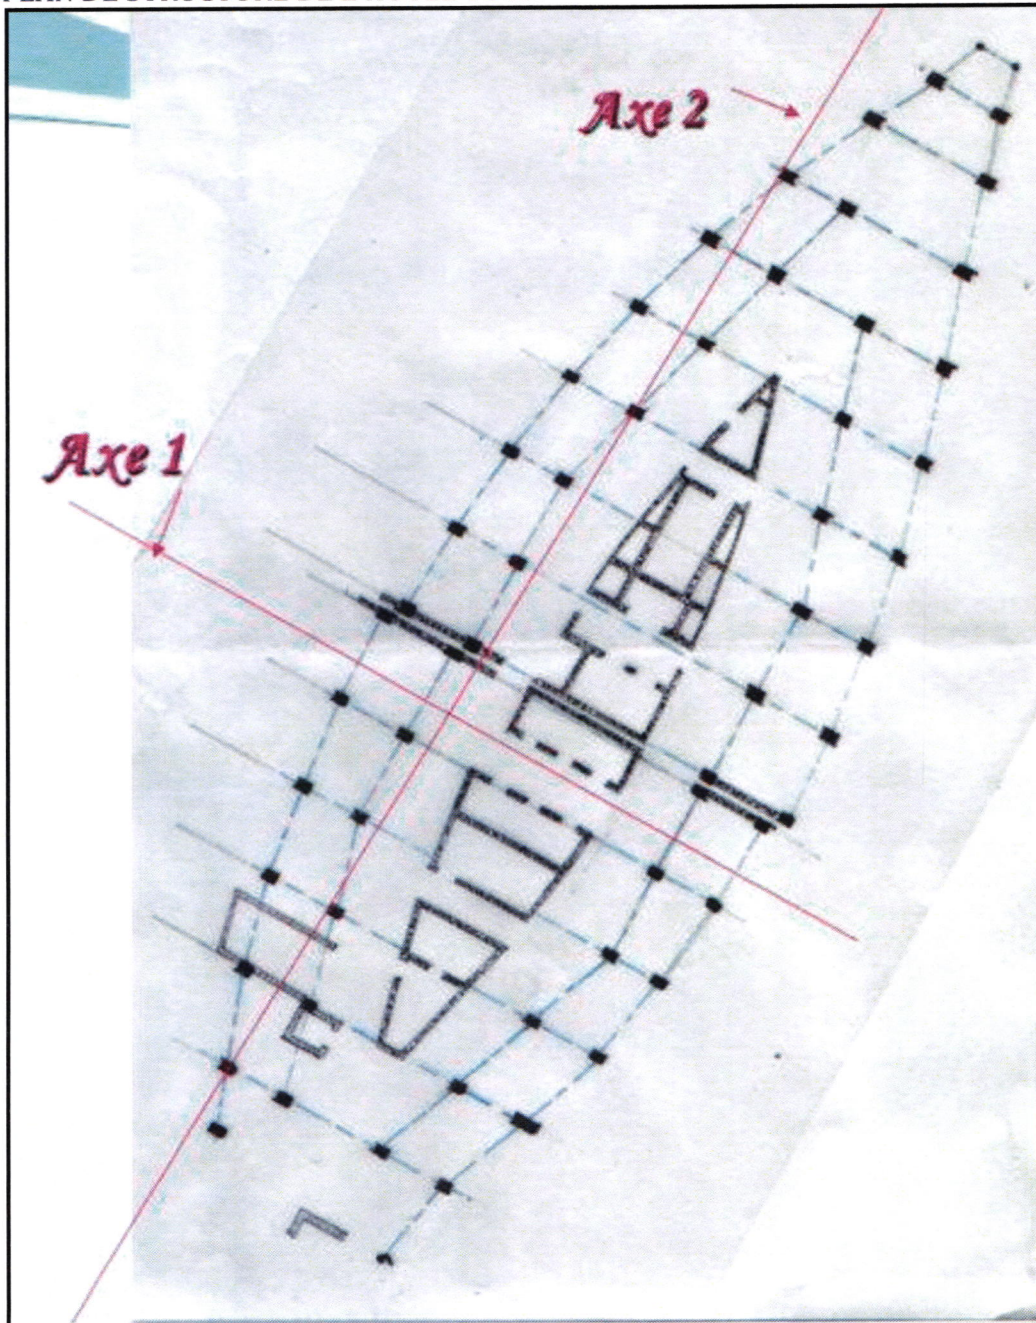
plan de structure de l'hôtel Sheraton Oran.
